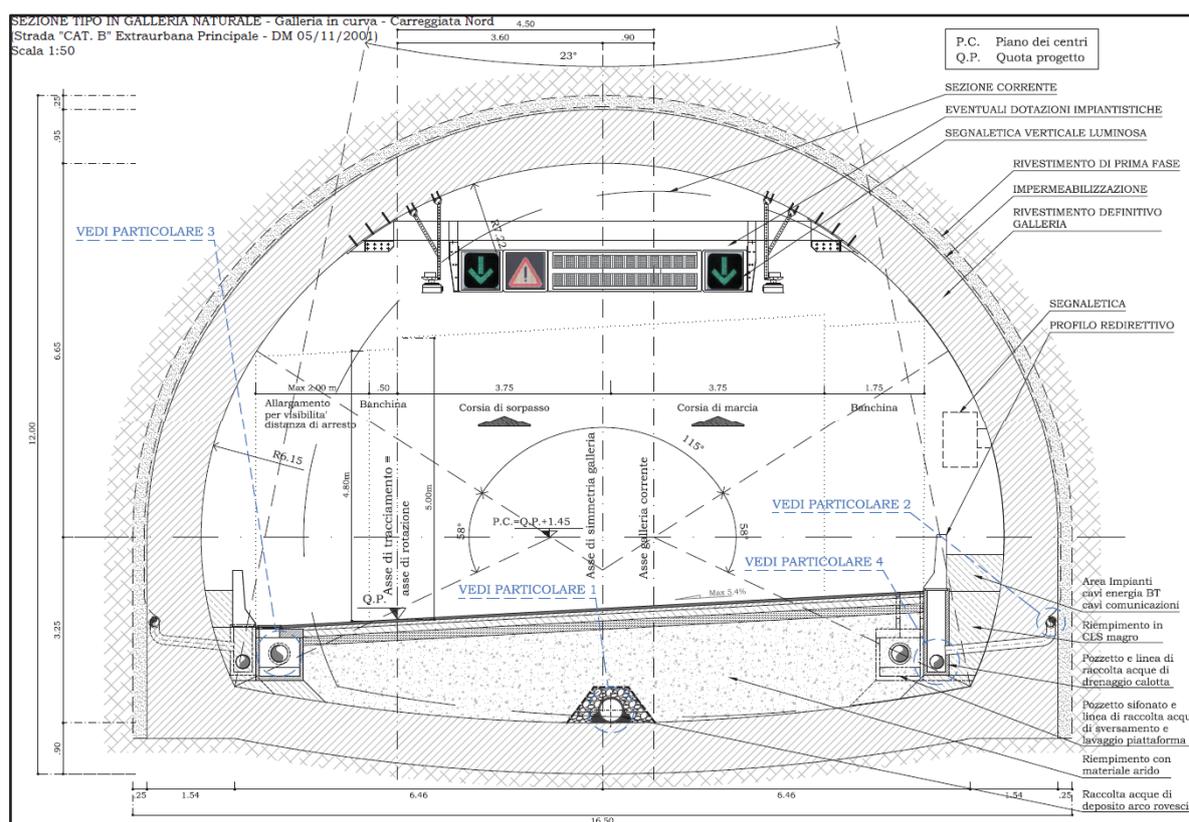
Sezione tipologica galleria naturale ed elementi di arredo.
